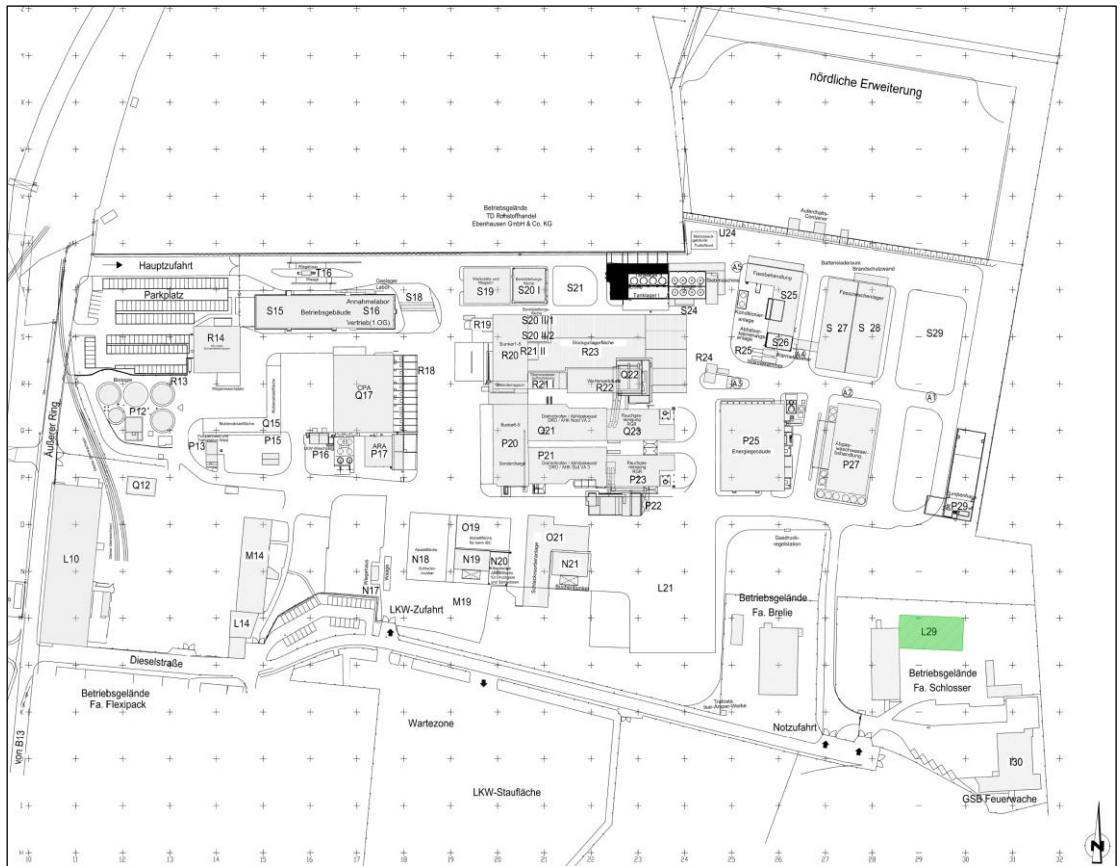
Lageplan der geplanten Stückgutlagerhalle L29 (Quelle: IA-Tech GmbH)
